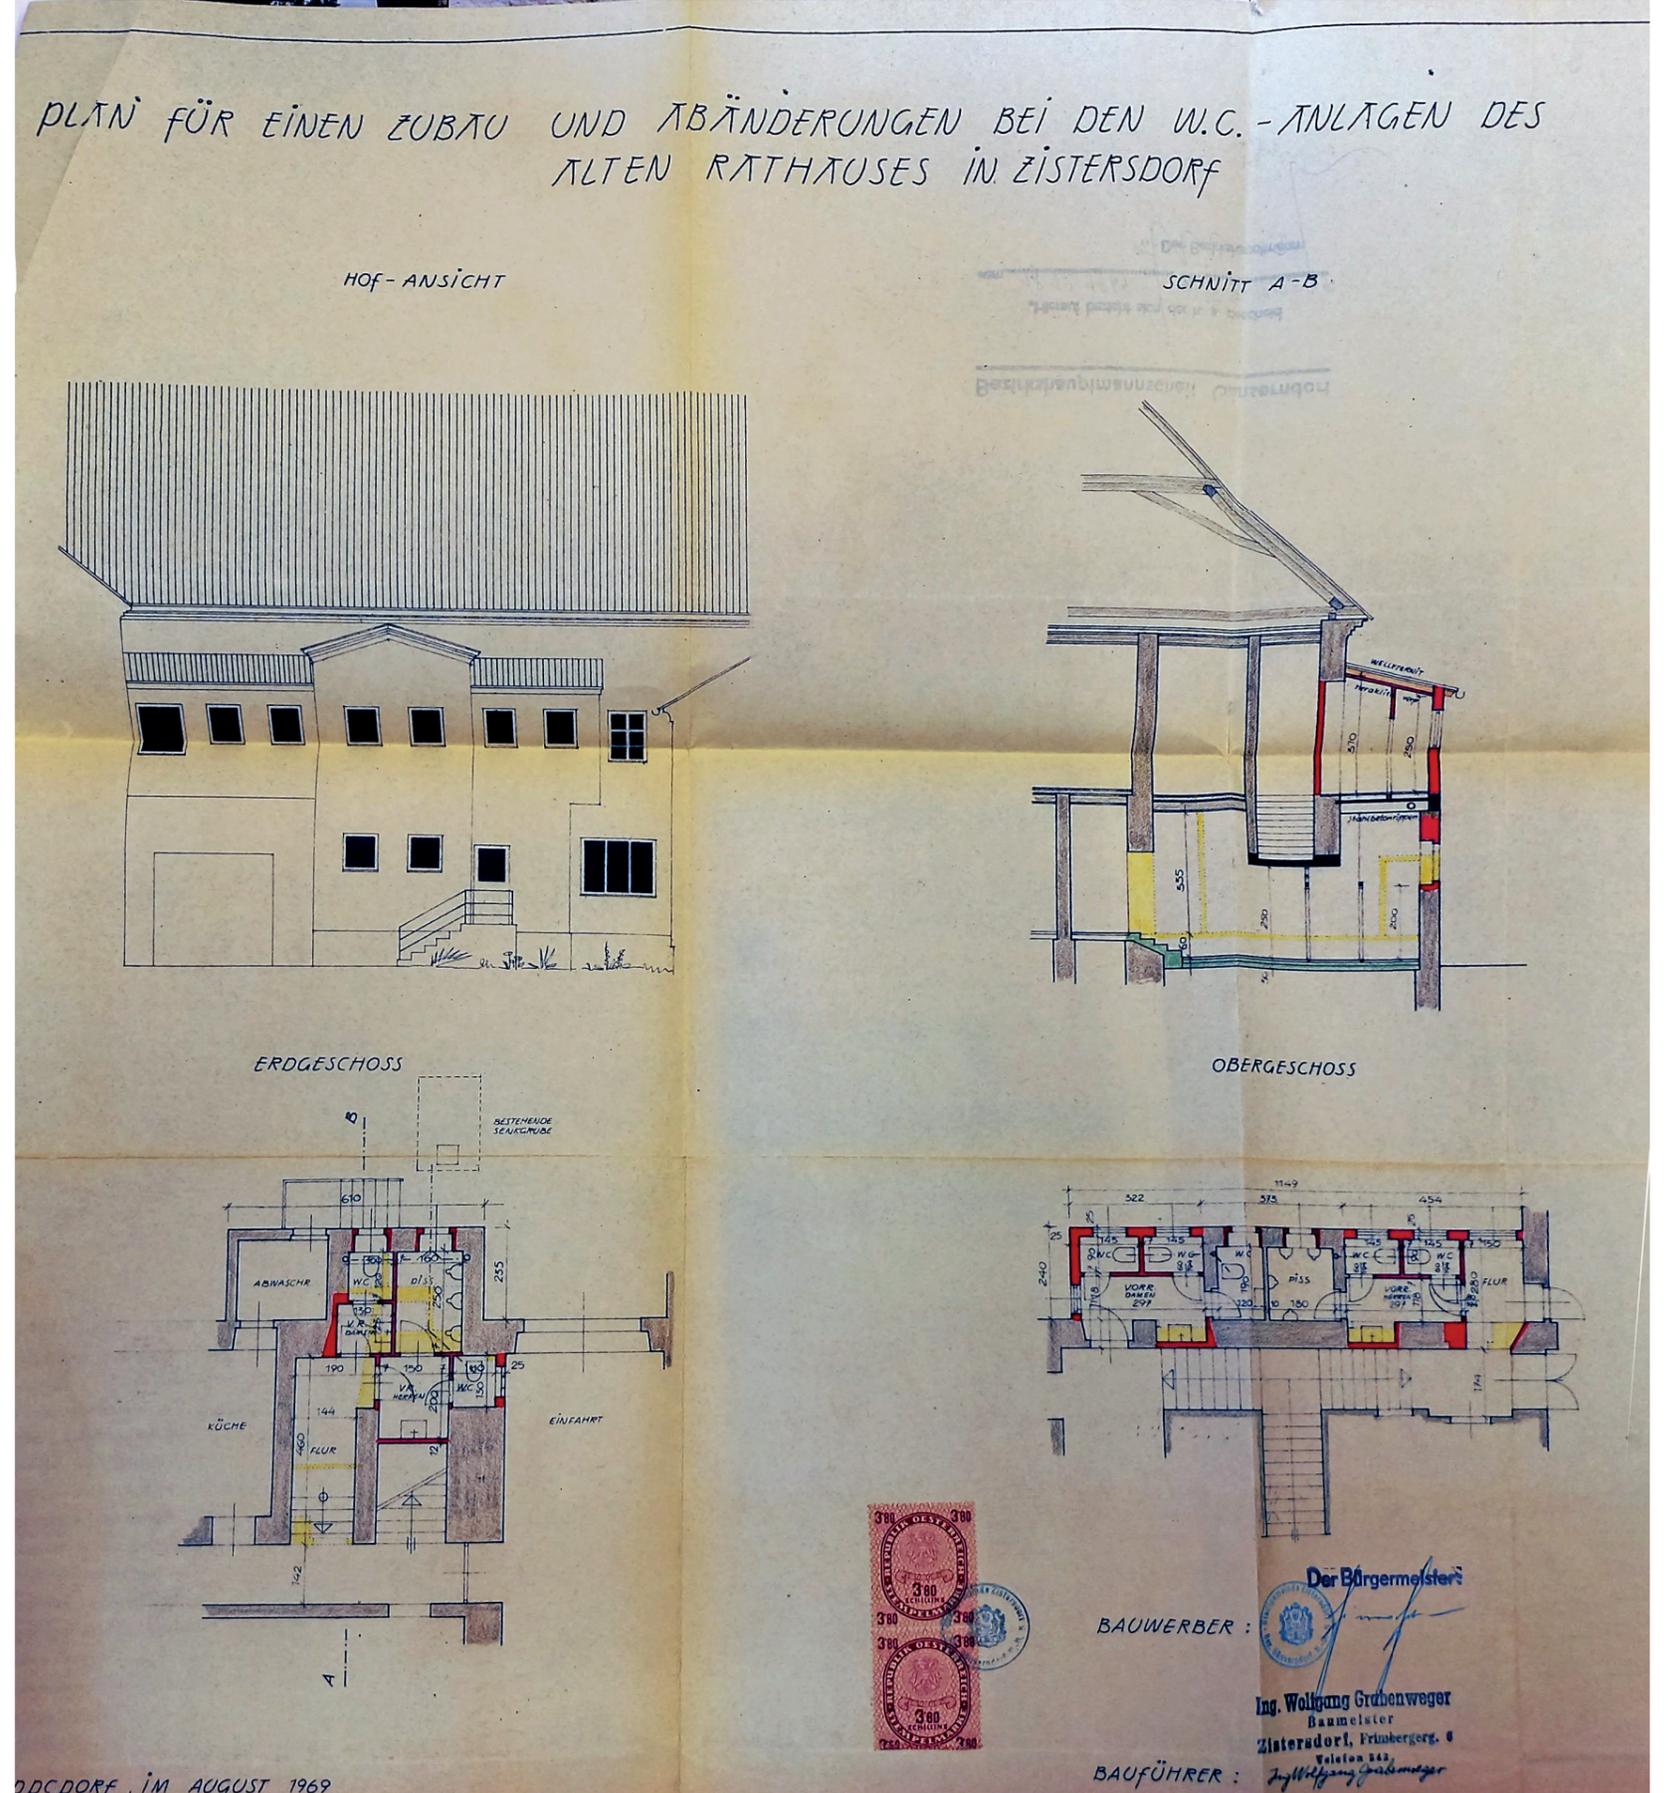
Plan vom Ausbau der WC-Anlagen im Norden des Straßentrakts, 1969, Bauakt
